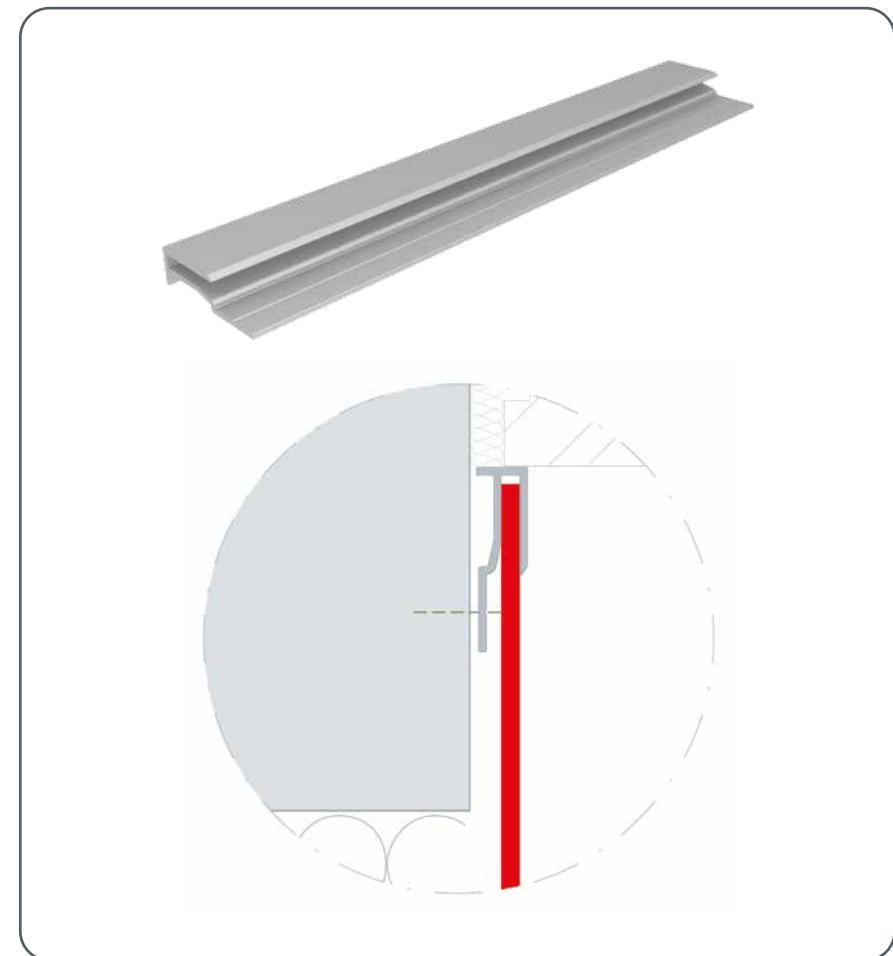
• Profilo a U (fissaggio all'interno dell'intradosso)
